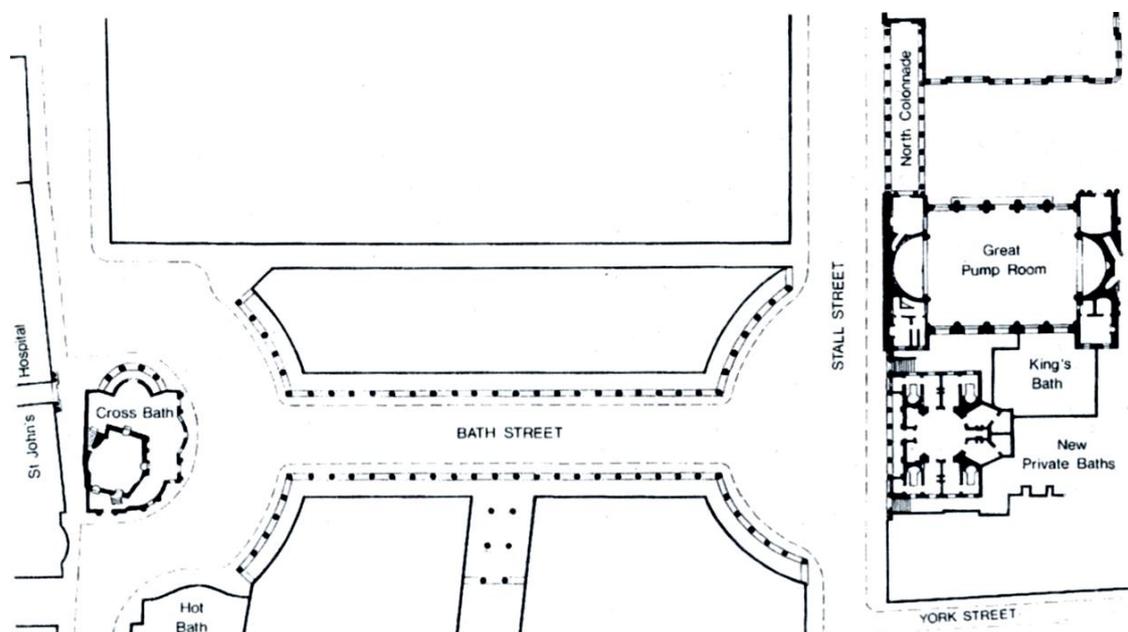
“Bath Street”, Bath (Gran Bretagna). Pianta
